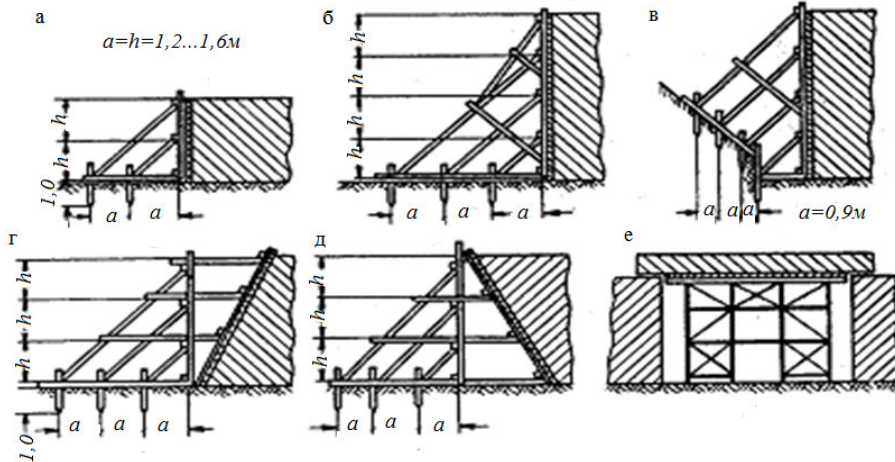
Схеми кріплення великощитової опалубки: а – при висоті блоків до 3 м; б – при висоті блоків до 5 м; в – при близькому розміщенні укосів котловану; г, д – для похилих поверхонь; е – при бетонуванні балок і перекриттів
